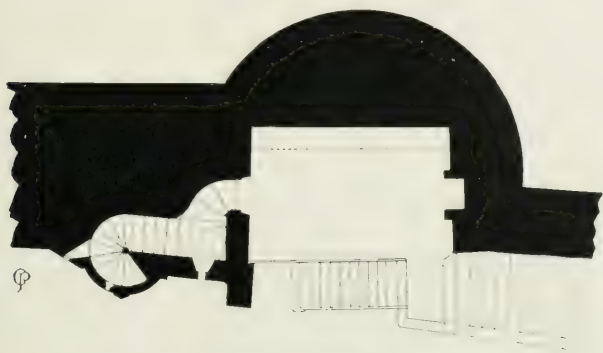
Maison de l'Arcade, Plan à hauteur de l'entresol.
